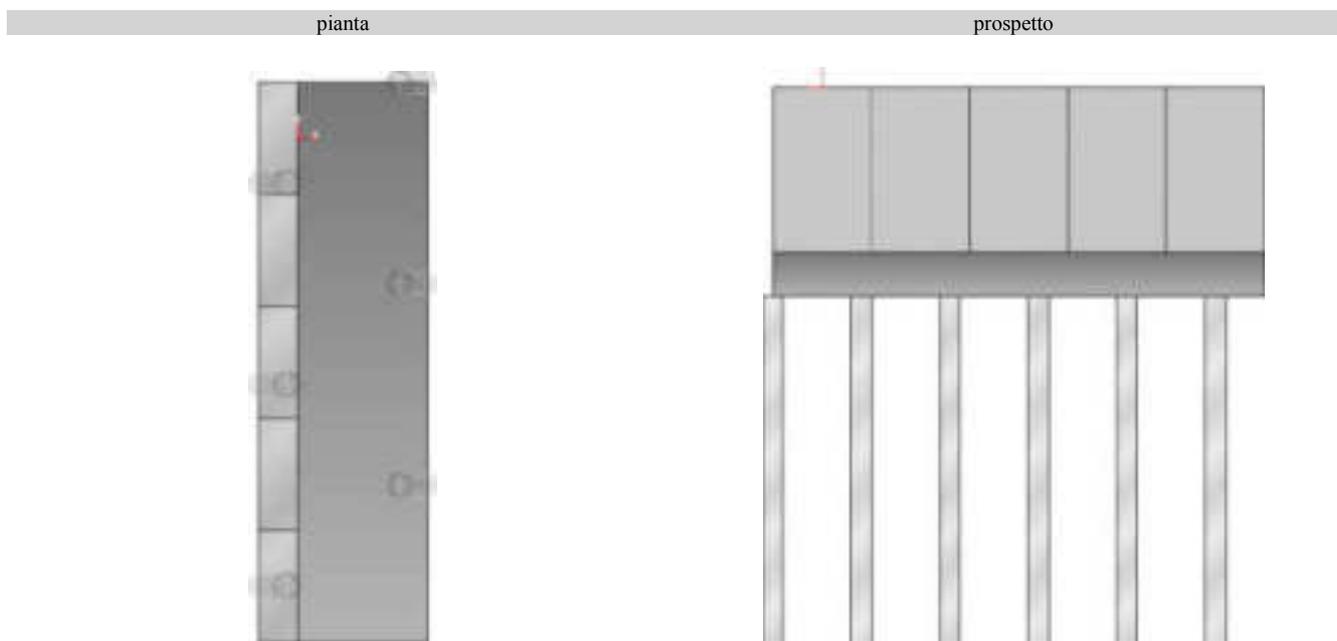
Pianta e Prospetto Modulo Tipo
